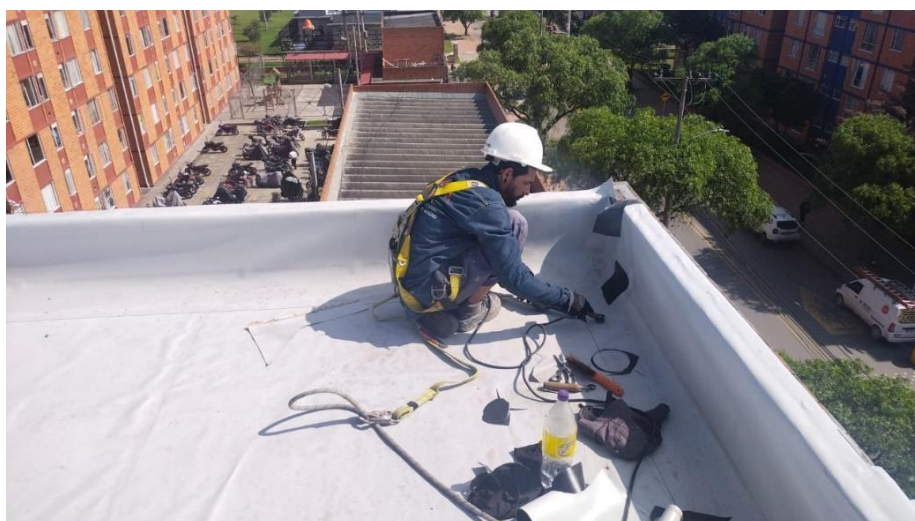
Aplicación de poliuria en el perímetro de la cubierta (Porvenir)
